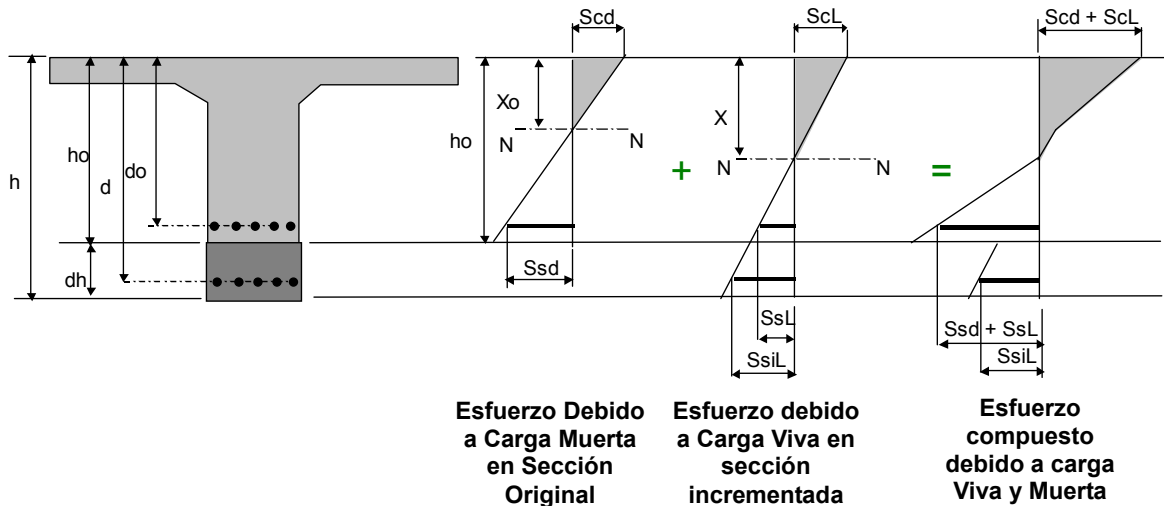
Esfuerzo en refuerzo de viga de RC con Incremento de Peralte de Viga
